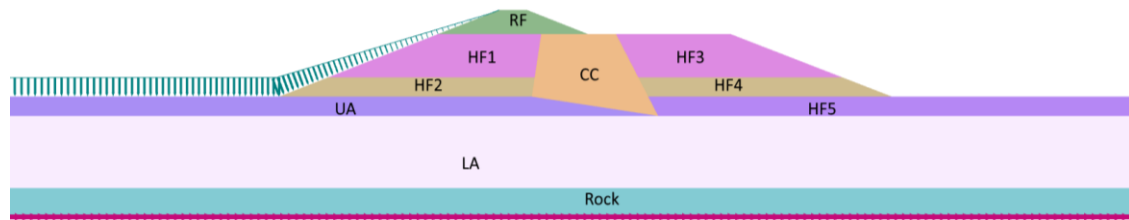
Modélisation du barrage Upper San Fernando (différentes zones des matériaux constituant le barrage et sa fondation).
